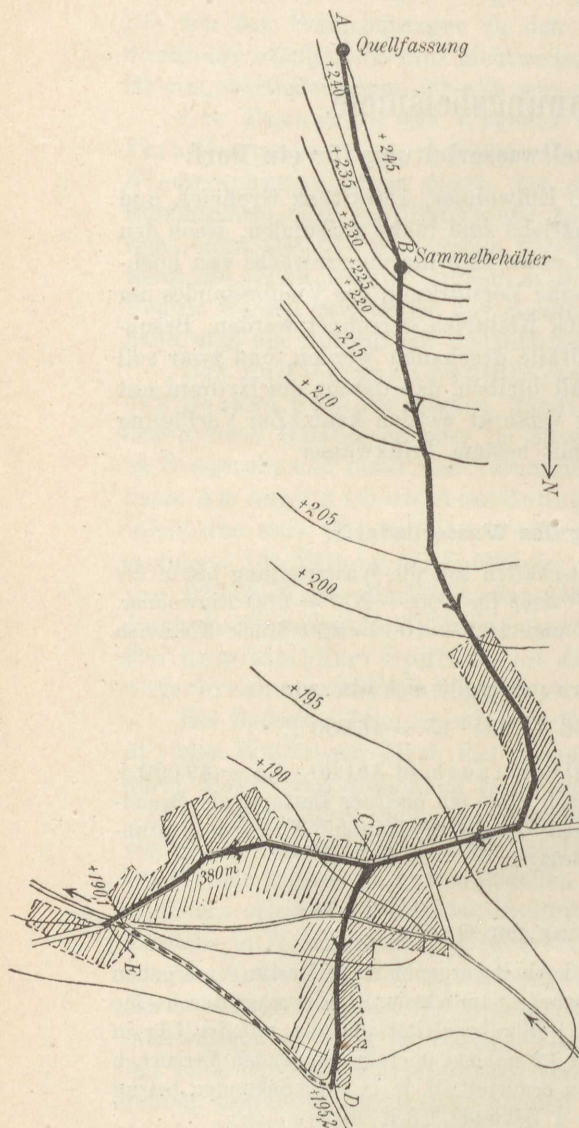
Quellwasserversorgung eines Dorfes. Lageplan.
